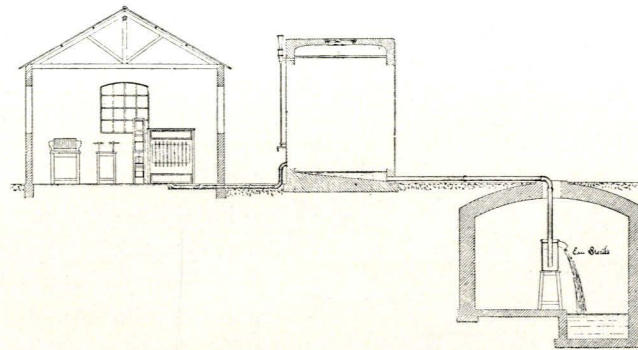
Sezione dello Stabilimento di Emmerin.
